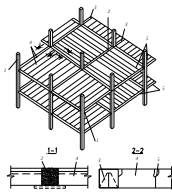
Схема кістяка: 1 – колони із замкнутих сталевих профілів; 2 – ригелі; 3 – консолі; 4 – збірні плити з ніздрюватого бетону; 5 – міжплитне зашпаровування швів.
